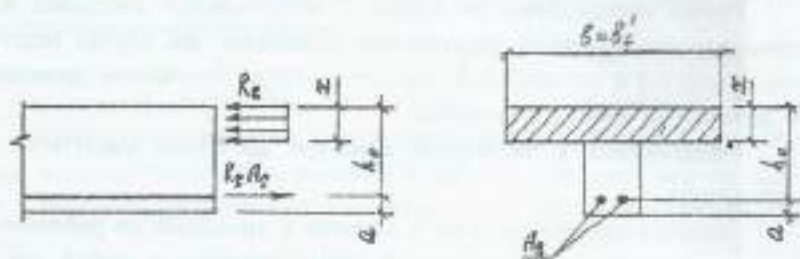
Расчетная схема плиты по нормальному сечению
